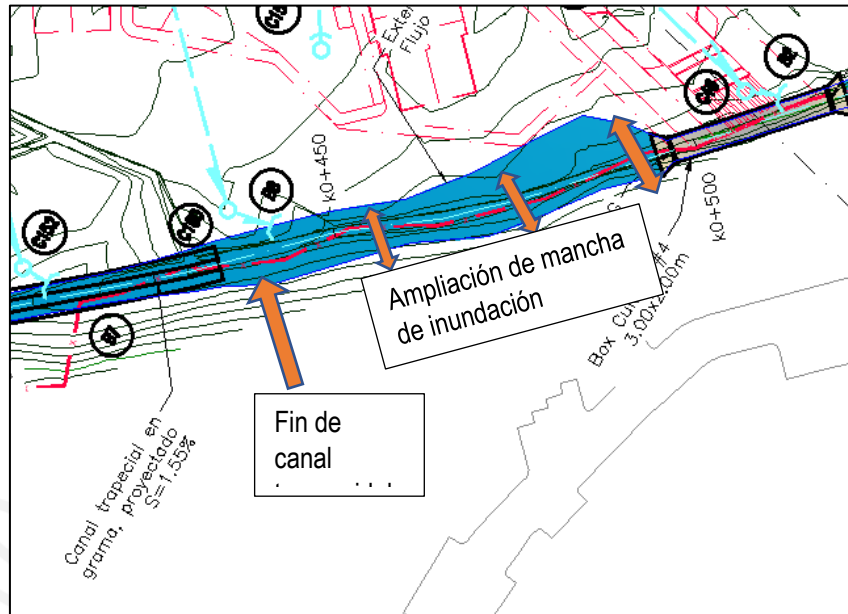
Planta de tramo de fuente donde finaliza la adecuación de la sección hidráulica de la fuente y se incrementa la mancha de inundación antes de la entrada al Box Culvert N°4 proyectado.
